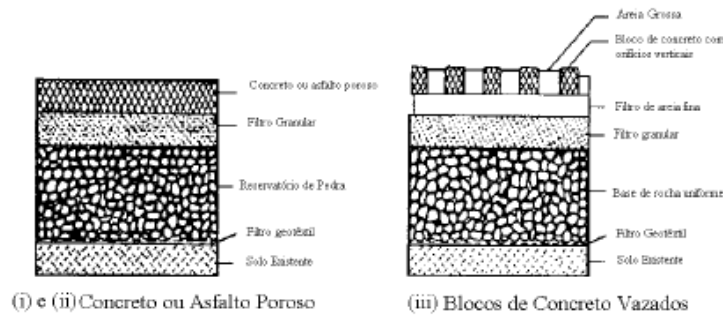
Pavimento permeável (URBONAS e STAHR, 1993).
